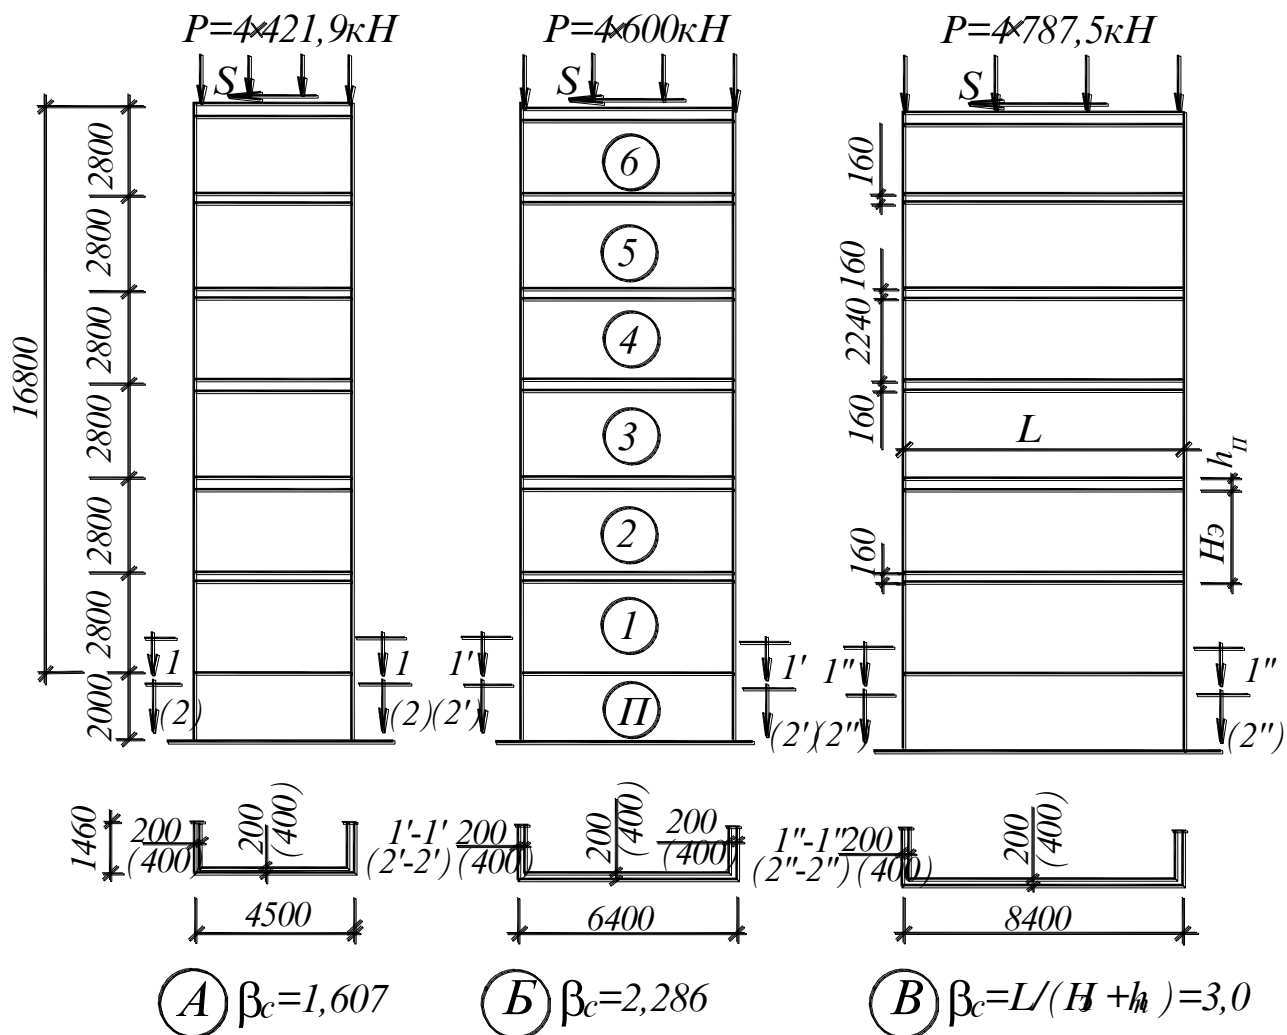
Типы стен, подвергавшиеся расчету на ЭВМ.
